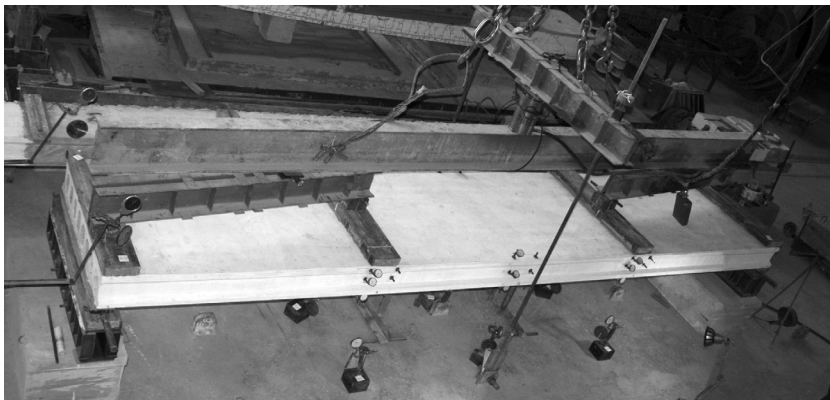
Общий вид испытаний многопустотной железобетонной плиты на изгиб с кручением
